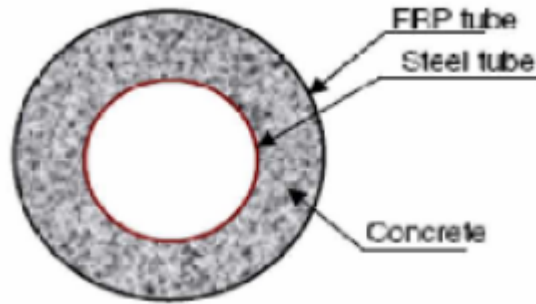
Section droite des poteaux mixtes en double peaux[49].
